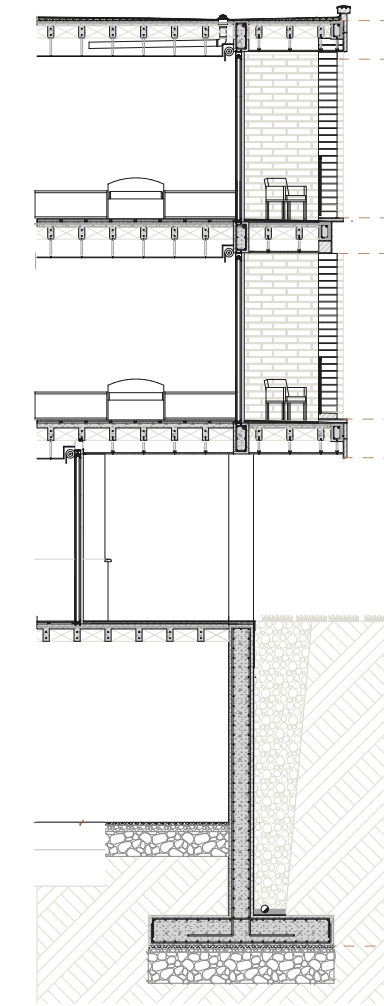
Sección constructiva. Fuente: Autoría propia.
